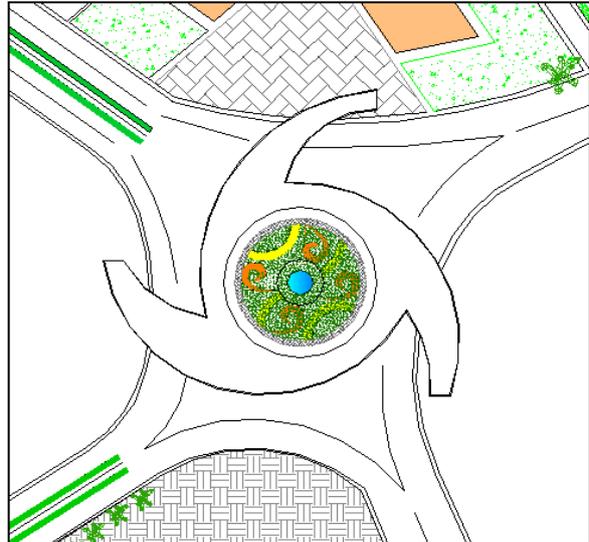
vue en plan du nœud centrale après l'intervention.
